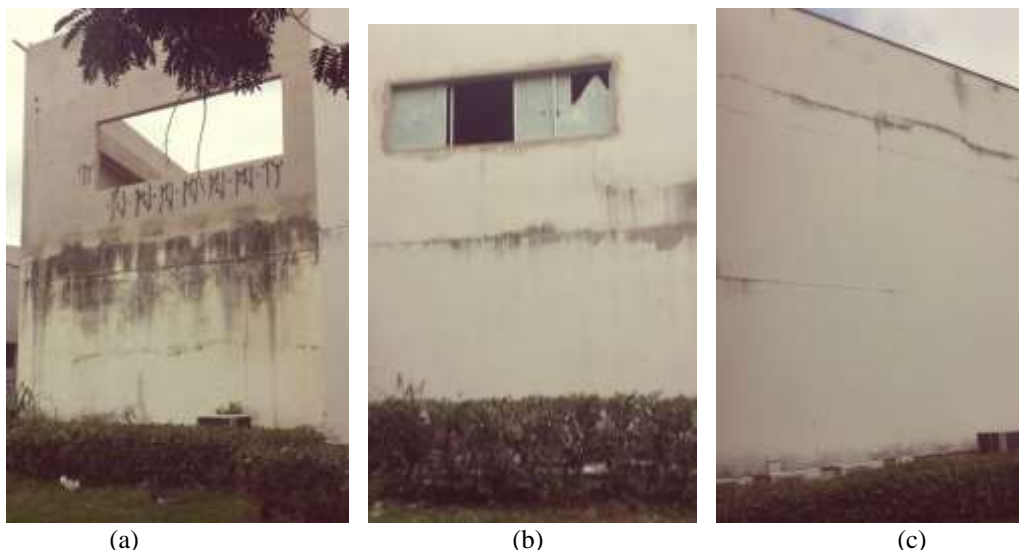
(a) Fissura horizontal com machamentos- fachada sudoeste, (b) Fissura horizontal com pequenos manchamentos - fachada noroeste, (c) Fissura horizontal próxima a platibanda – fachada noroeste.
